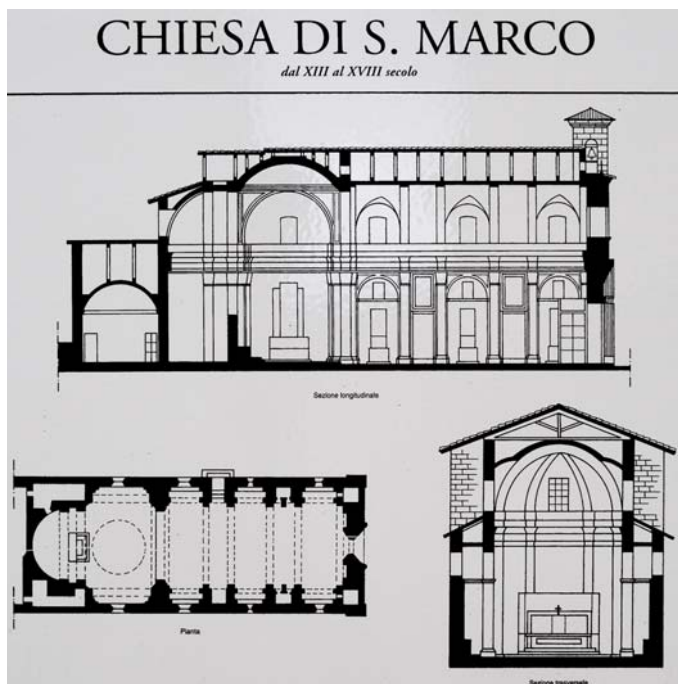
Grundriss, Längs- und Querschnitt der Kirche (AD0931)
